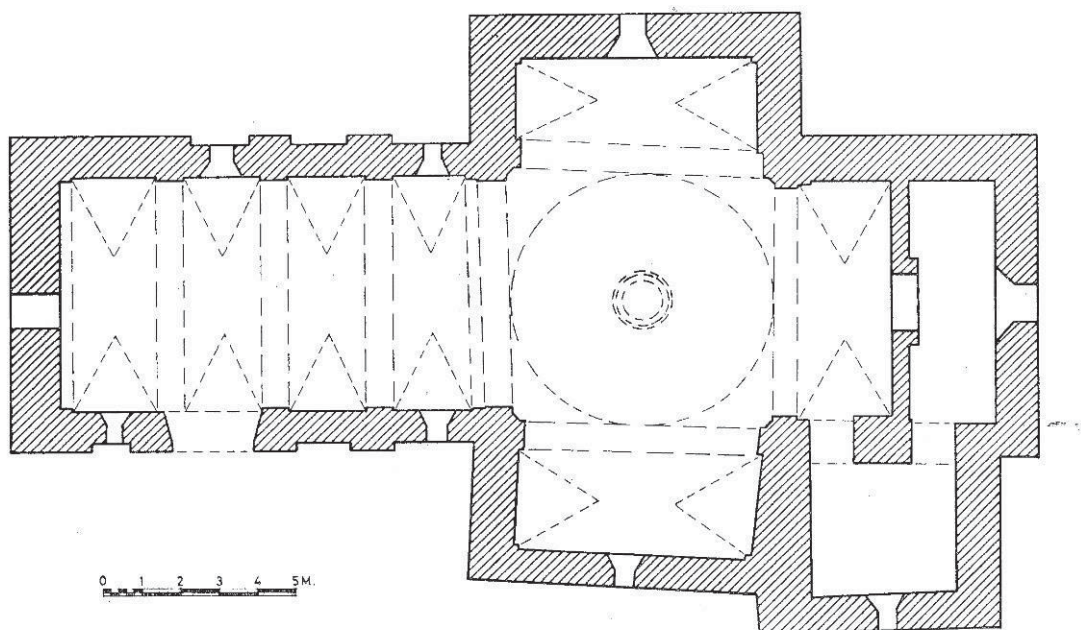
Planta de la ermita de Mojados (fuente: ZALAMA RODRIGUEZ, M. A., Ermitas y santuarios..., p. 95)
